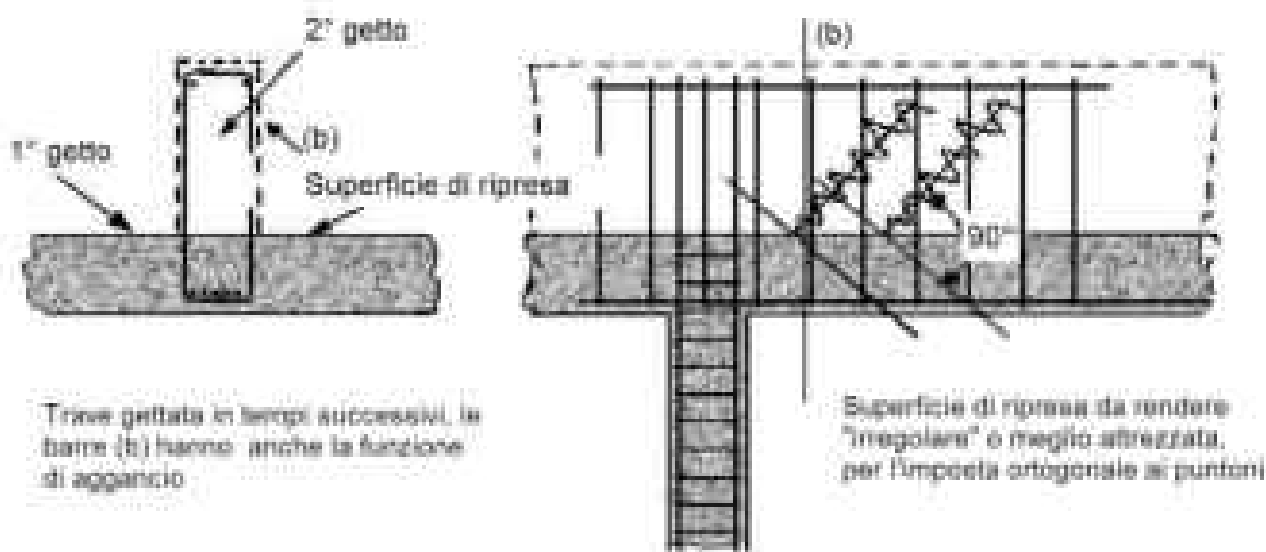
Modalità di ripresa del getto su travi di spessore elevato
